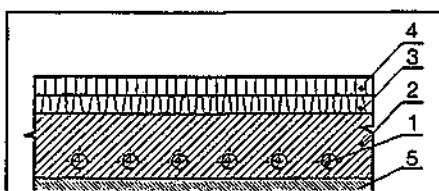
Panou radiant de plafon cu țevi înglobate în beton:
